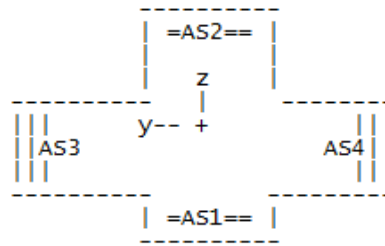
Схема армирования №2, С выделением угловой арматуры
